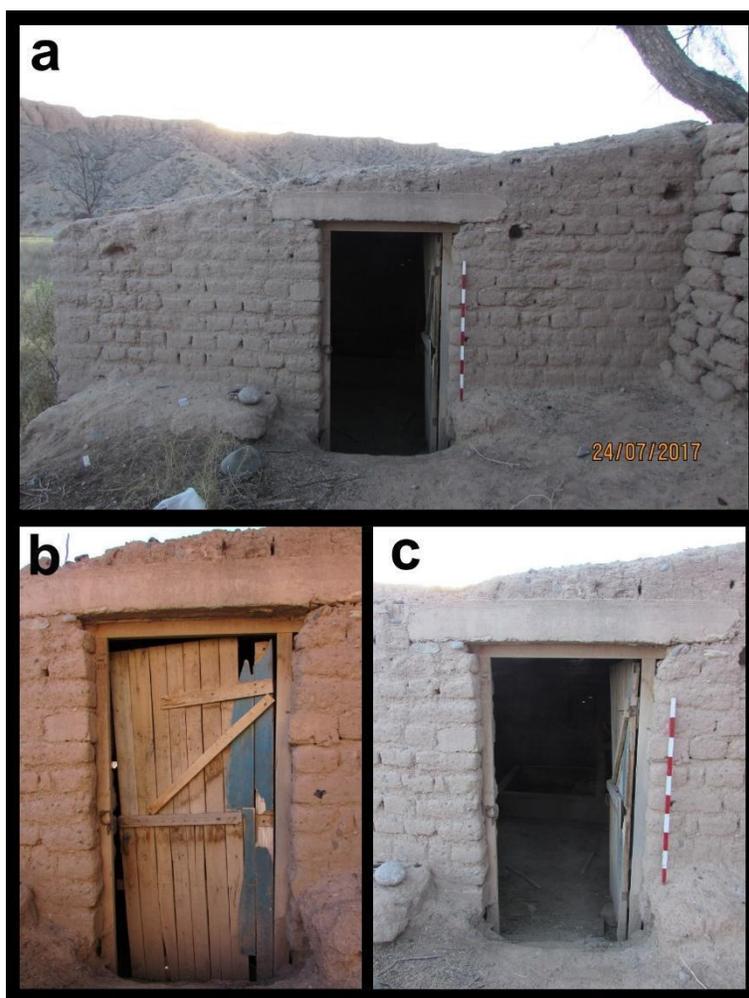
sector de ingreso del R6. Referencias: (a) vista exterior del muro SE del R6 y la abertura de ingreso a la habitación; (b) detalle de la abertura del muro SE con la puerta actual del R6; (c) detalle de la abertura del muro SE con la puerta abierta.
